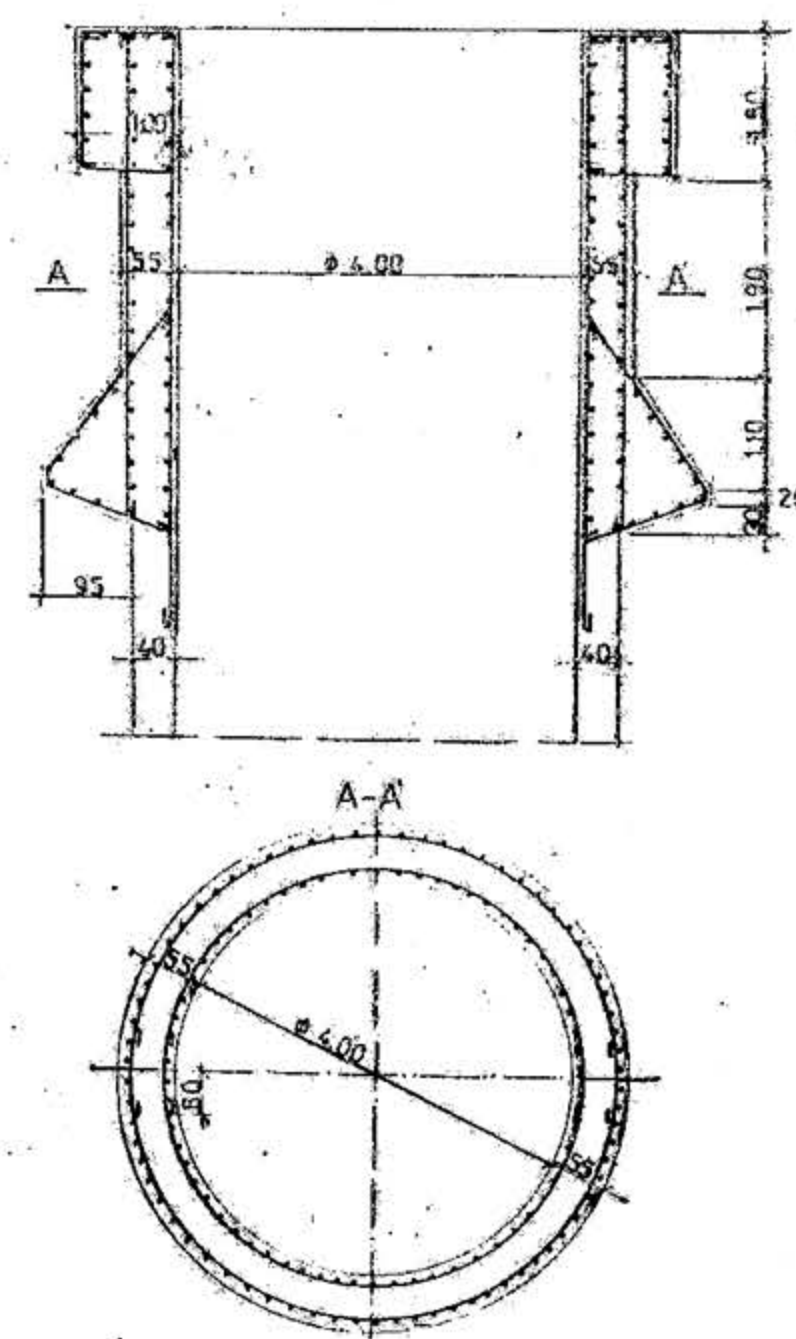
Susținerea în beton armat a gulerului de puț.
